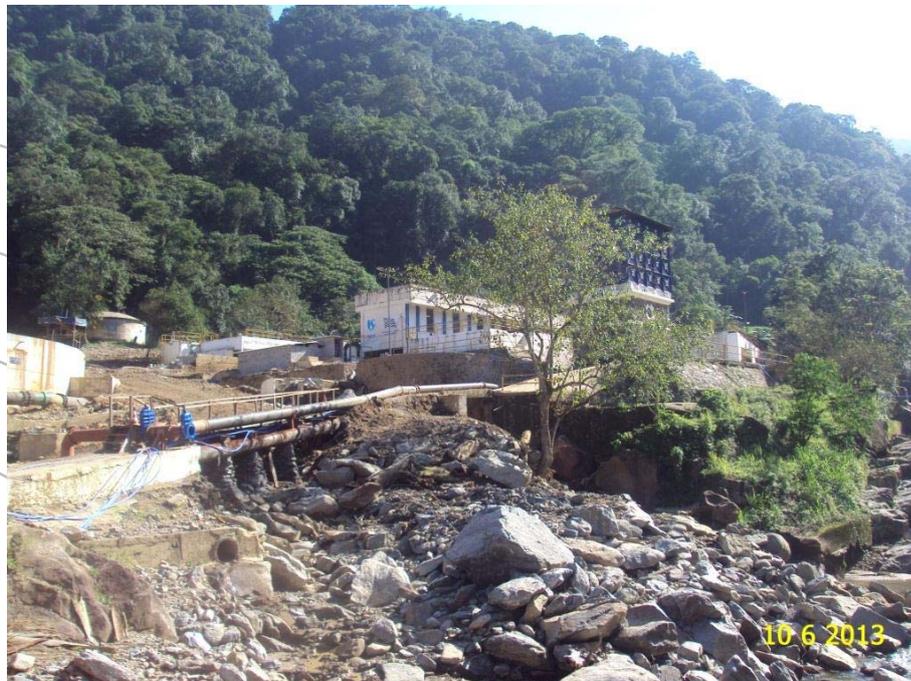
Vista geral da área da E.T.A. Pilões, posteriormente à execução da limpeza.
